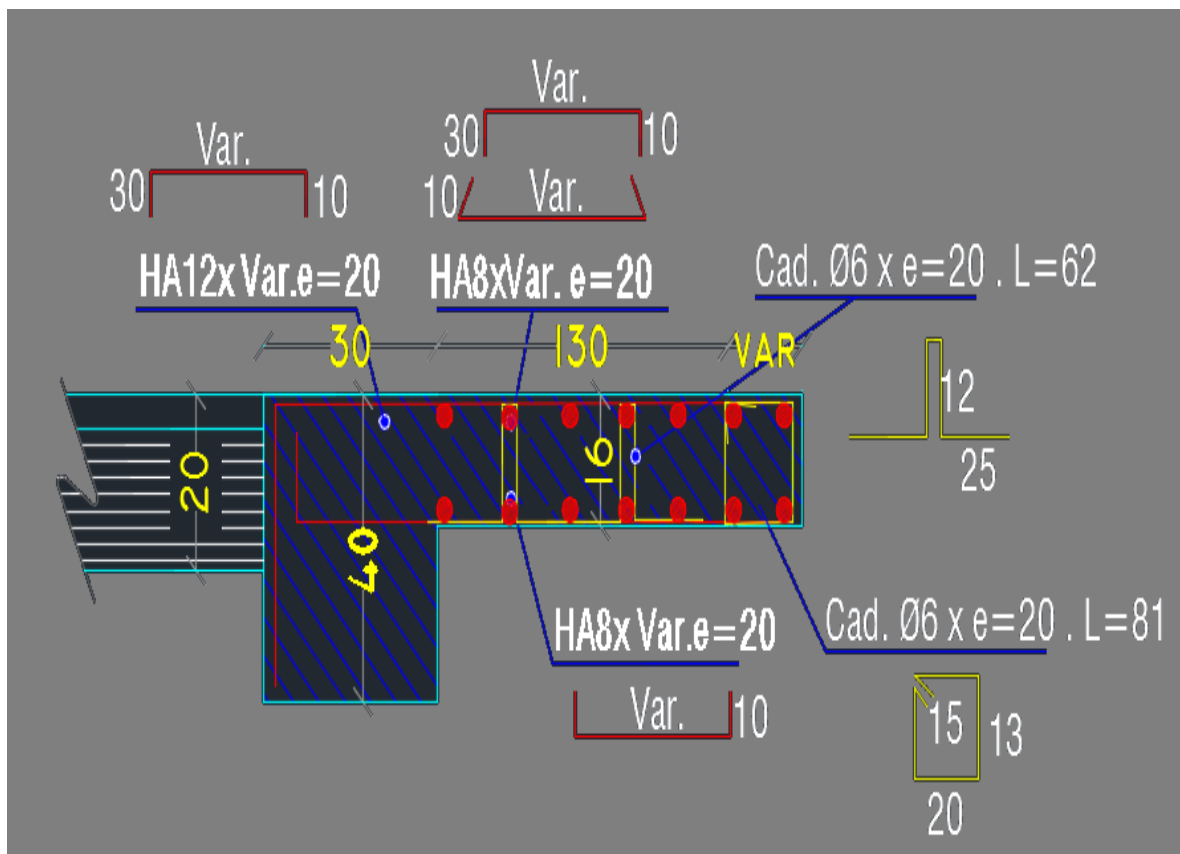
Ferrailage de la dalle pleine (balcon)
